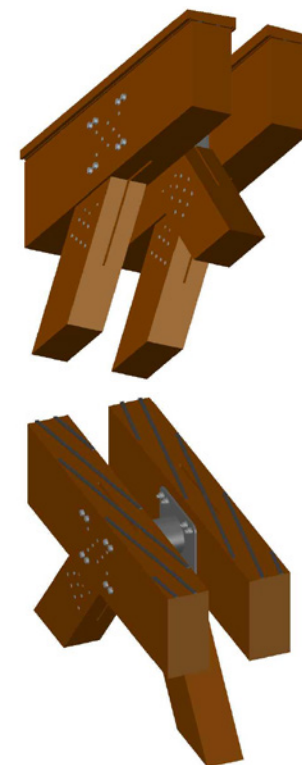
Detaillering dekplanken Pieter Smitbrug
